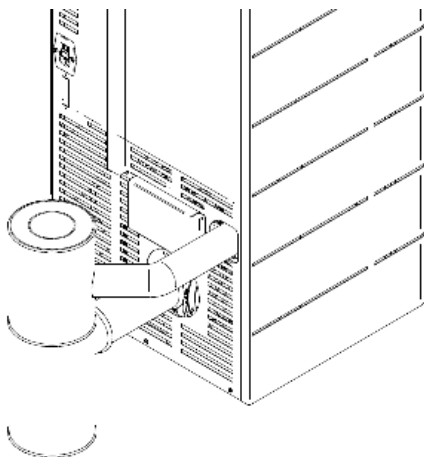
Ajuste coaxial inspección de T y con una pierna horizontal levante
